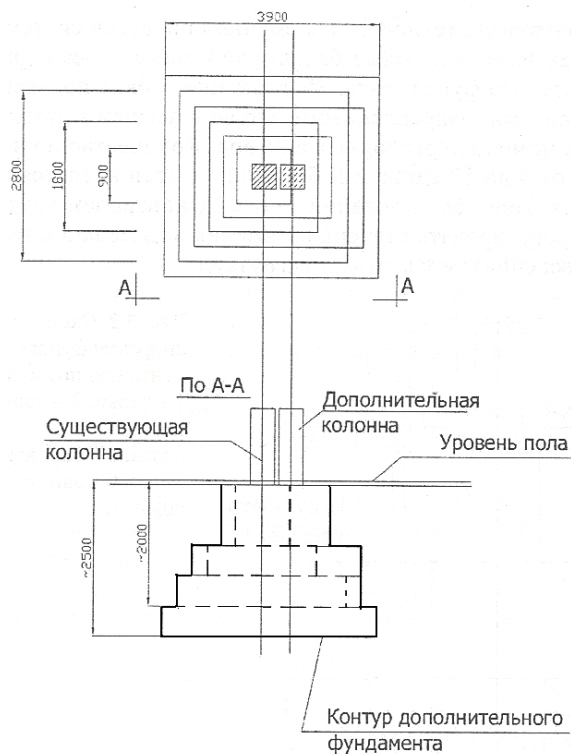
Сопряжение старого и нового фундаментов при установке дополнительной колонны
